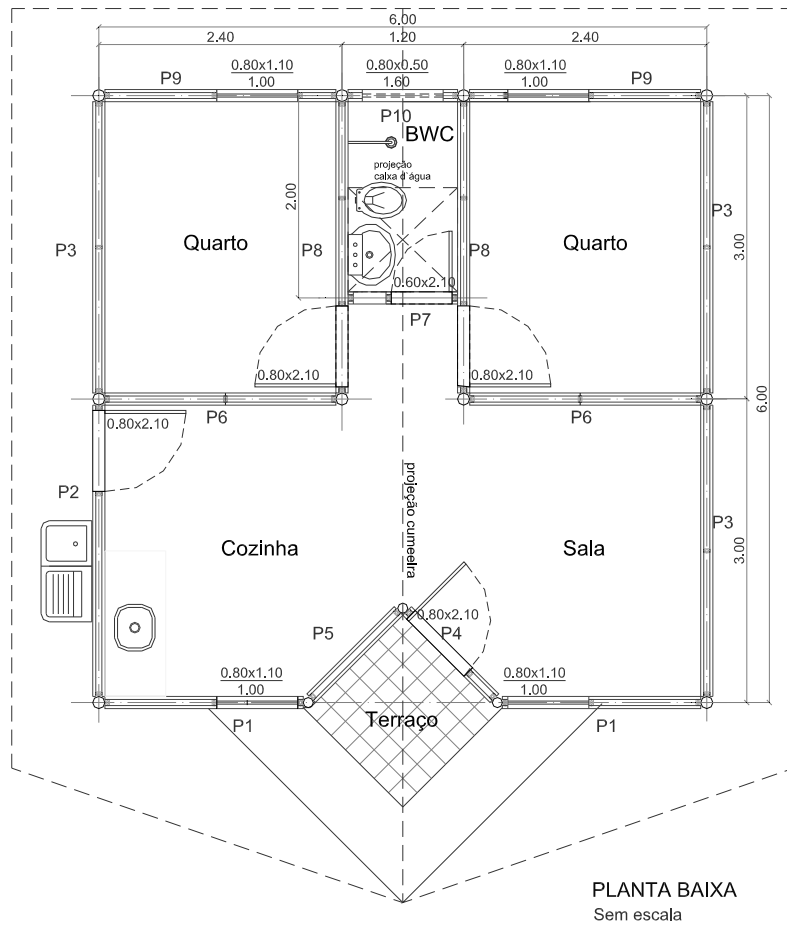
Planta baixa da edificação em estudo (unidade de medida: m)
